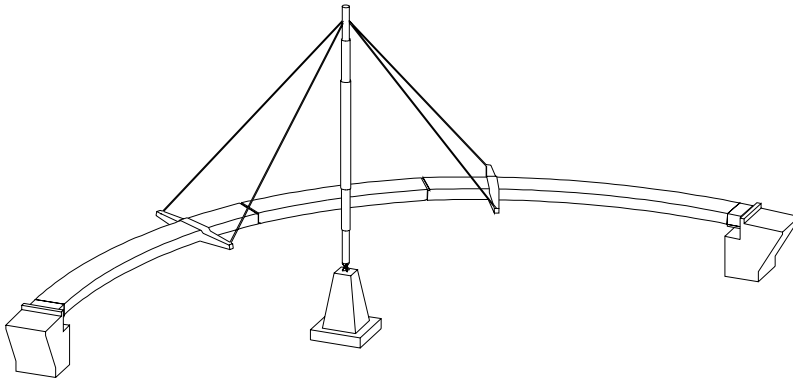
Isometrie Vorentwurf Brücke Hochstetten (viertelkreisförmig gekrümmter Grundriss)
